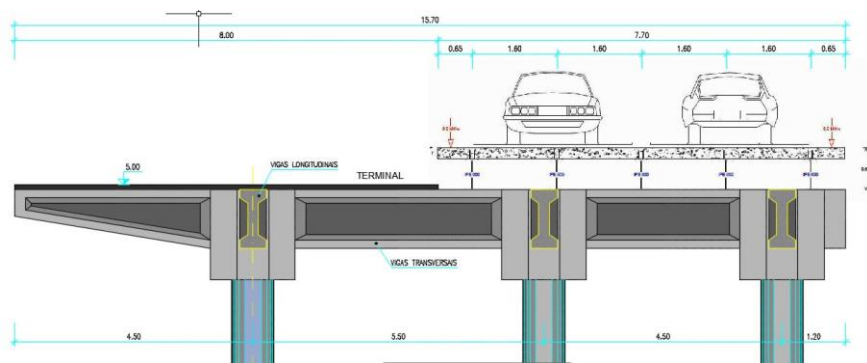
Perfil transversal (Estrutura mista - zona de alargamento)
